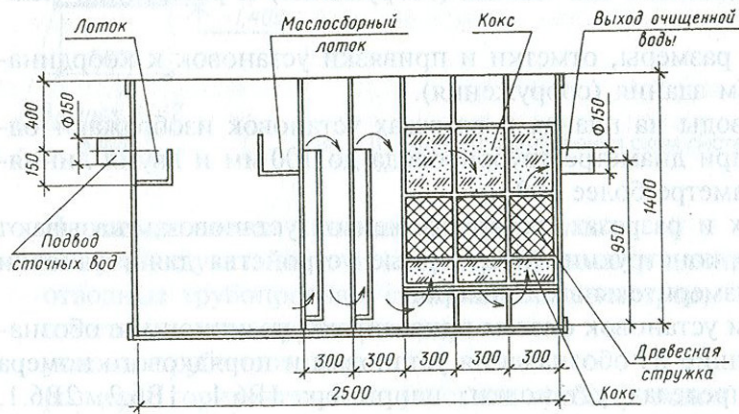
Пример оформления чертежа общего вида нестандартной нетиповой конструкции
